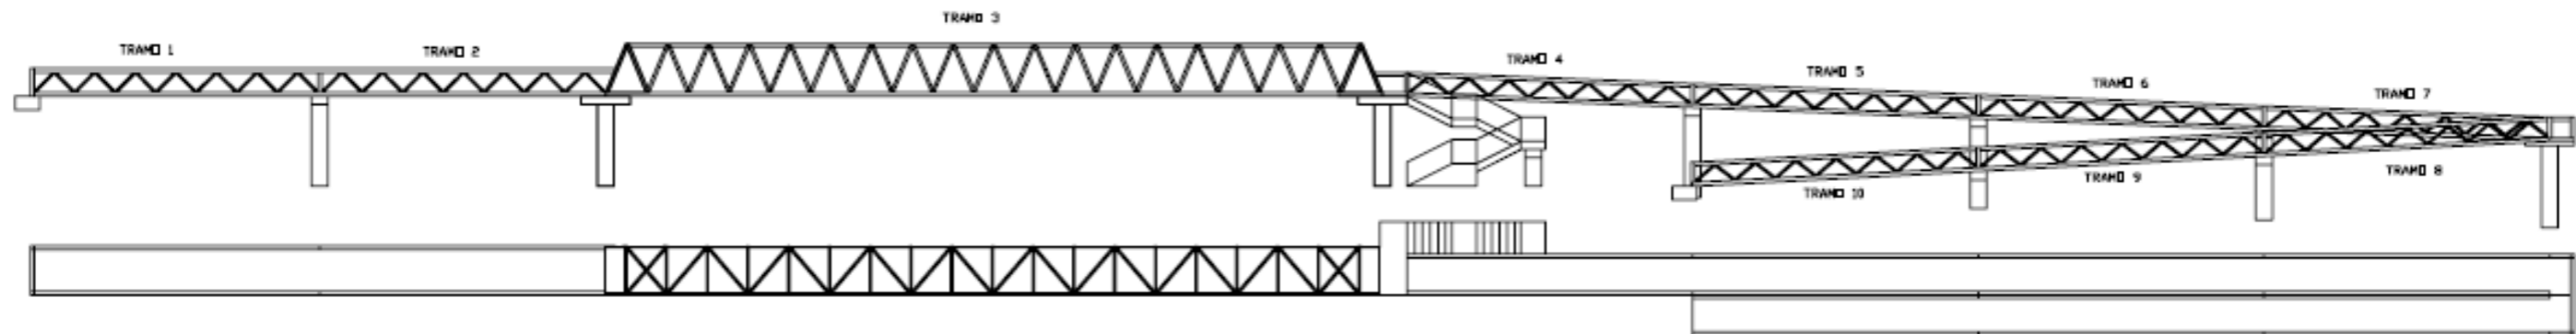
Diseño de pasarela peatonal y accesos en perfil y planta superior
